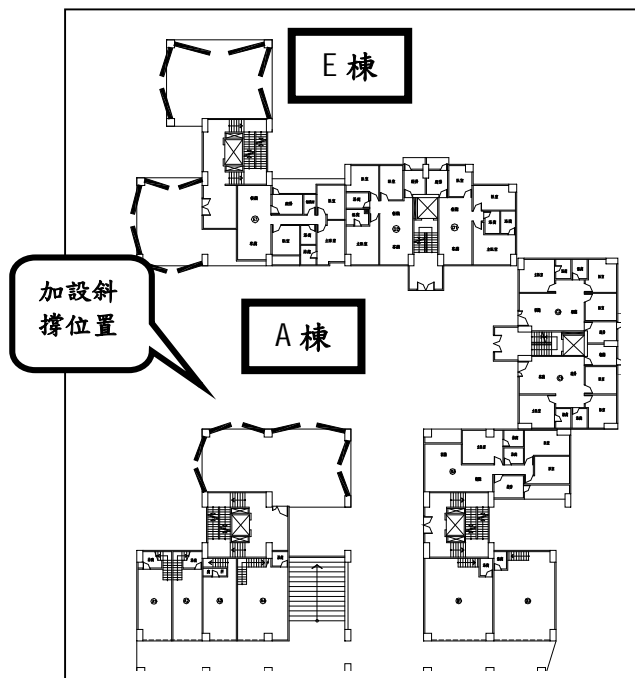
A、E 棟一樓開放空間補強斜撐平面位置
